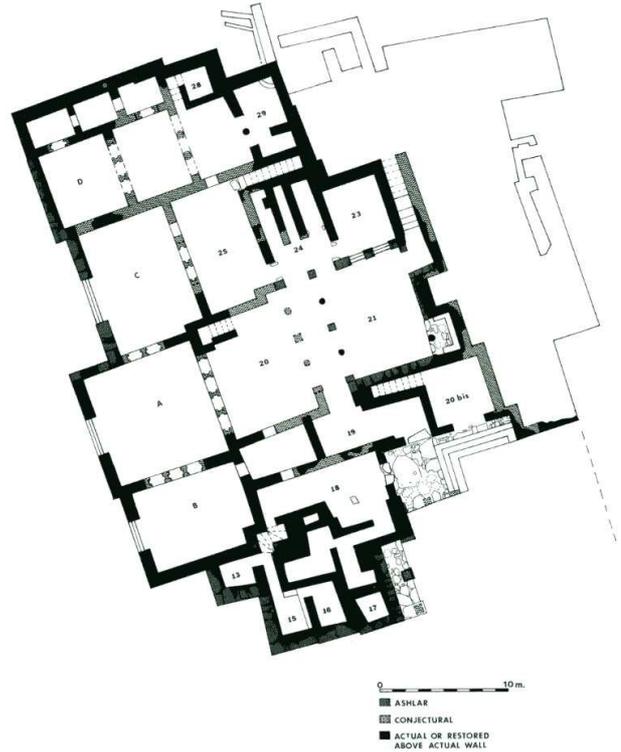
Gournia, Erdgeschoss des Palastes, Plan nach J. S. Soles
